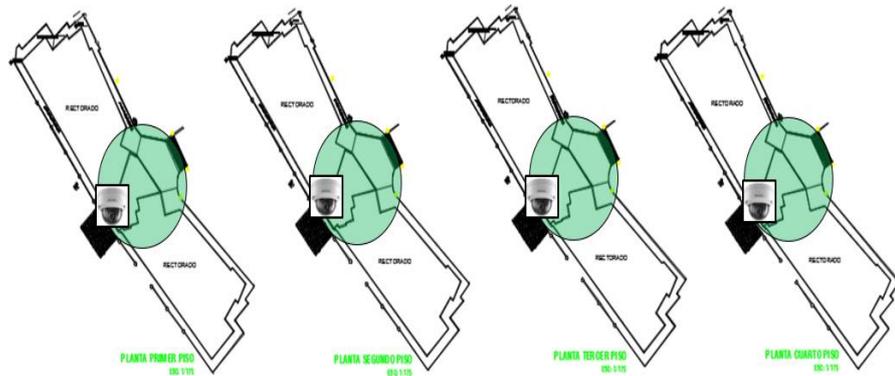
Plano de distribución de cámaras de vigilancia en pabellón de facultades.
